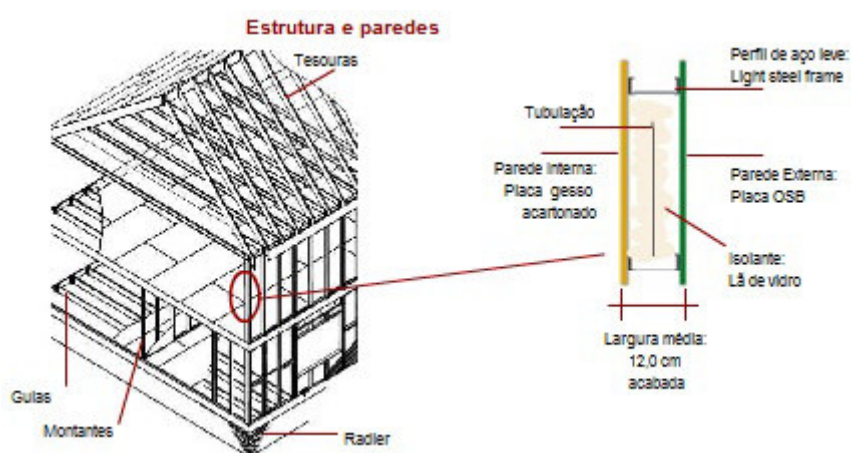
Esquema estrutural e corte esquemático de parede em Steel Framing
